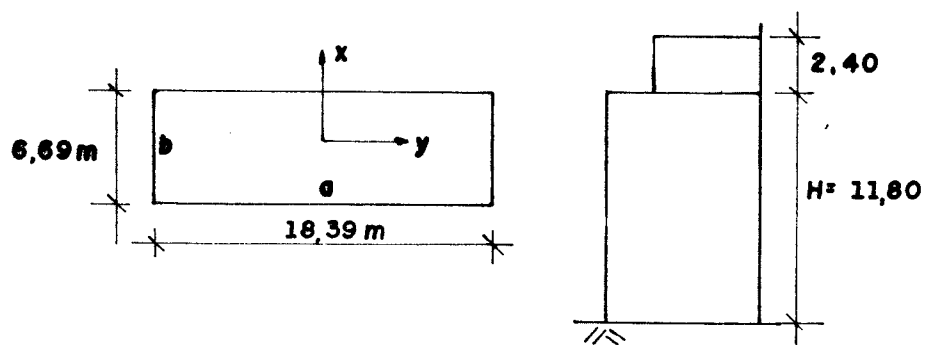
ESQUEMA DA PLANTA E CORTE DO EDIFÍCIO
